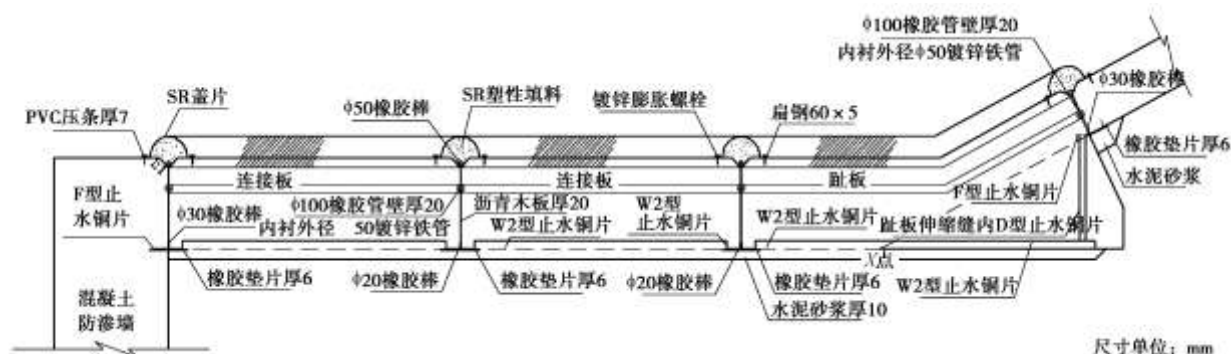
察汗乌苏面板坝面板与混凝土防渗墙联接方式及缝止水结构示意图
